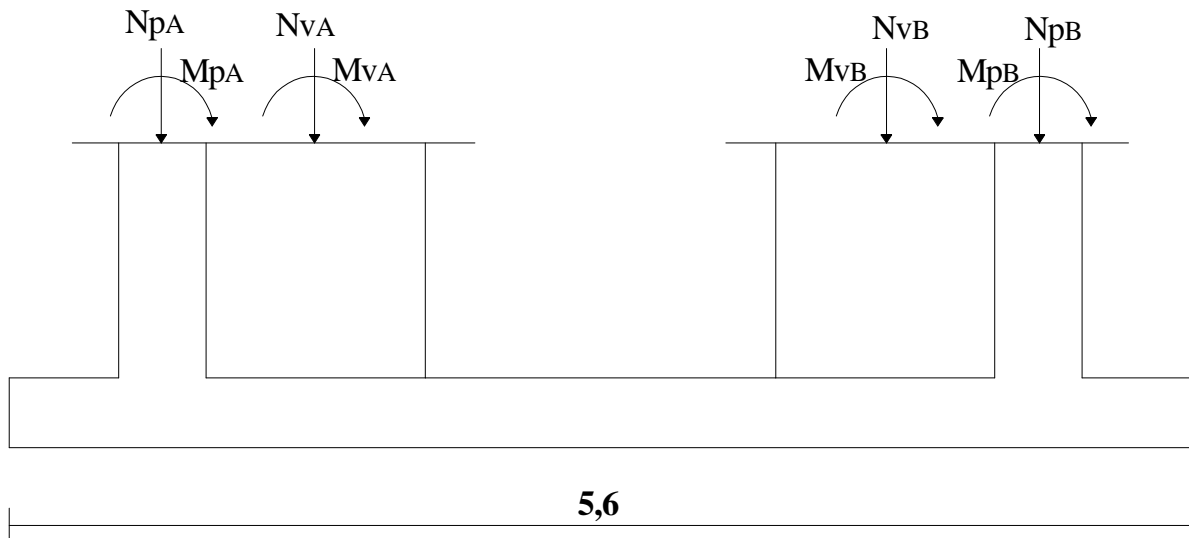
Sollicitations dans la semelle sous poteaux existants et voiles de renforcement.
